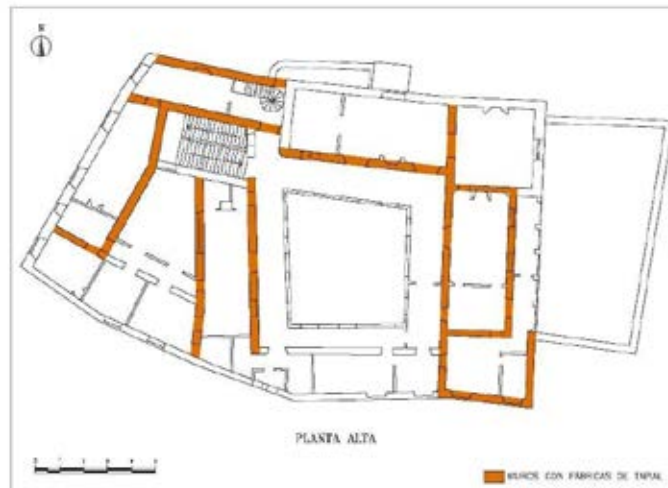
Casa de Calle San José 3. Planta alta. Muros constatados en tapial
